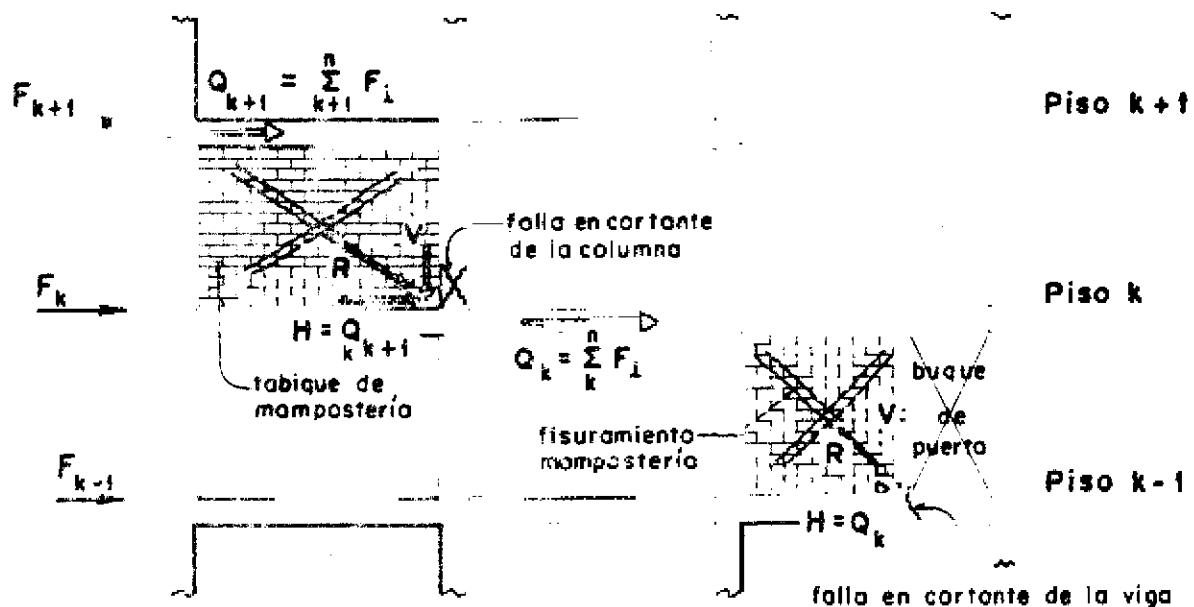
Falla en cortante de columnas y vigas debido a la interacción de los tabiques de mampostería. El cortante es transmitido al piso inferior como fuerza diagonal. La componente horizontal puede conducir a la falla de la columna, la componente vertical causar la falla de la viga.
